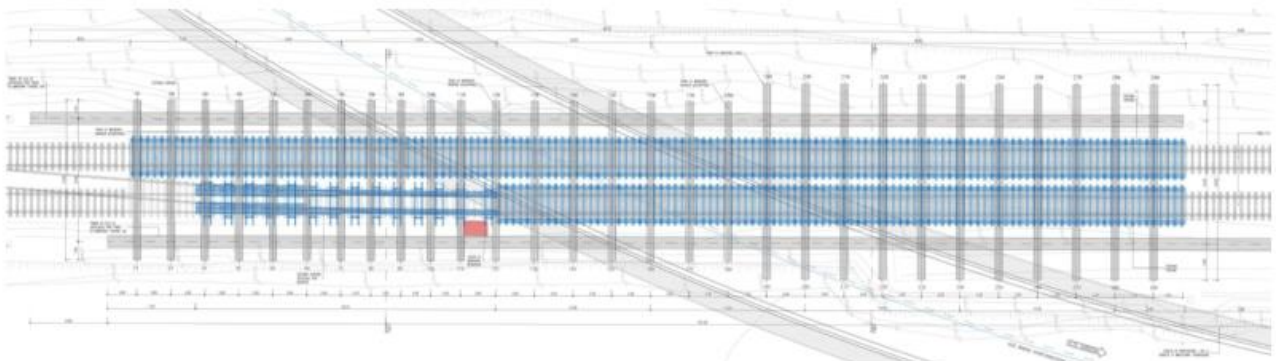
Ponte provvisorio "Sistema Verona" - Planimetria
